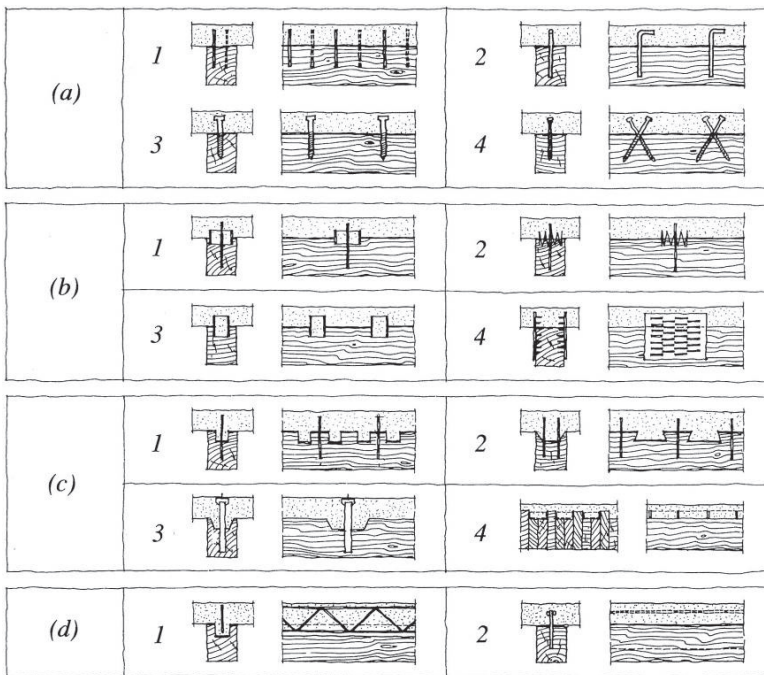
Beispiele für Holz-Beton-Verbindungen. (a1) Nägel, (a2) Stabdübel aus Betonstahl, (a3, a4) Schrauben, (b1) Einlassdübel, (b2) Einpressdübel, (b3) Stahlrohrstücke, (b4) Nagelplatten, (c1) vorgebohrte Vertiefungen mit Verbindungsmitteln gegen Abheben, (c2) schwalbenschwanzförmige Vertiefungen mit Verbindungsmitteln, (c3) Kernen mit vorgespannten Stahlstäben, (c4) Brettstapeldecke mit stählernen Scherplatten, (d1) Fachwerk aus Stahlstäben mit dem Holzträger verklebt, (d2) in den Holzträger eingeklebtes Stahlblech. (STEP 1995 Beitrag E13)
